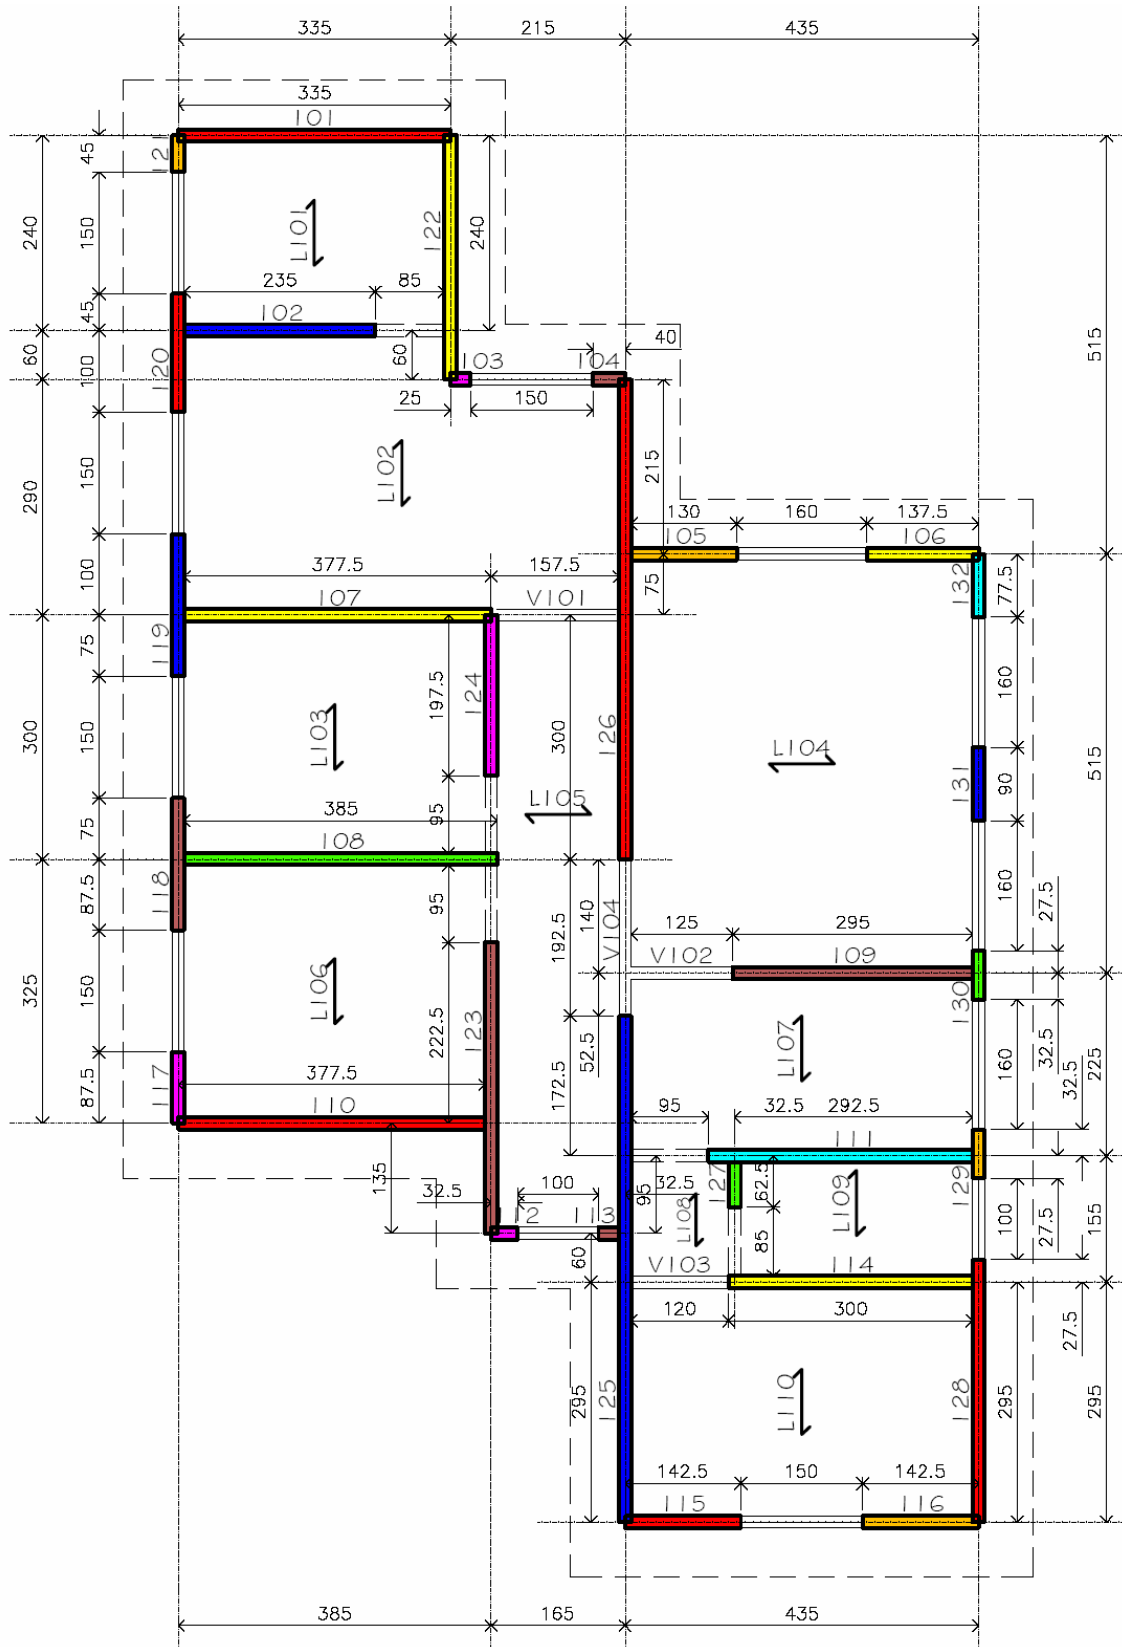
Estrutura do Exemplo L: pavimento superior
